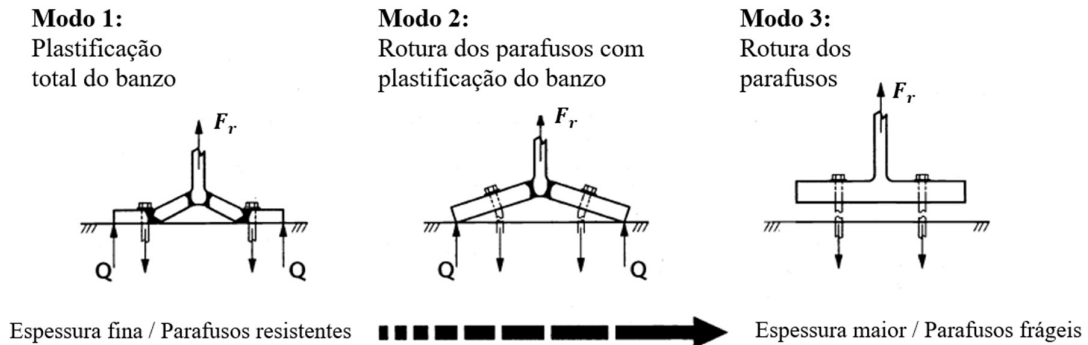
Modos de rotura de uma peça em T-stub equivalente. Adaptado da fonte: Joints in Steel Construction: Moment Connections, 1995.
